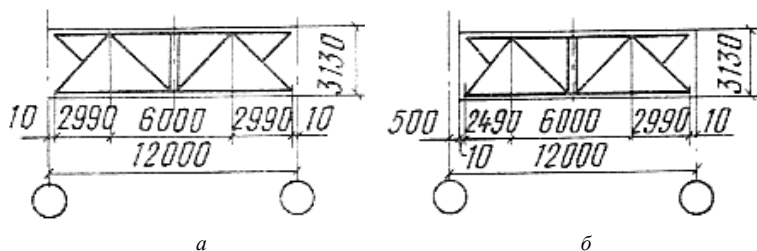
Подстропильные фермы нормальной высоты пролетом 12 м:
